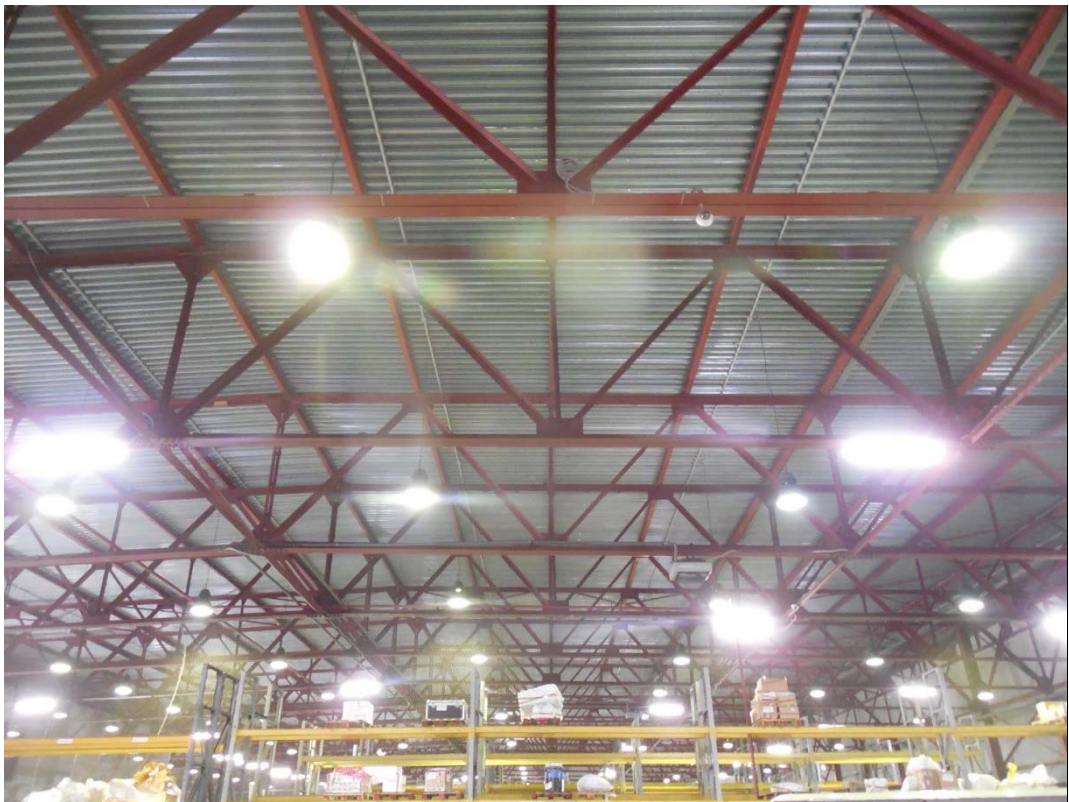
Общий вид на стропильные фермы, связи покрытия и кровельные прогоны.
